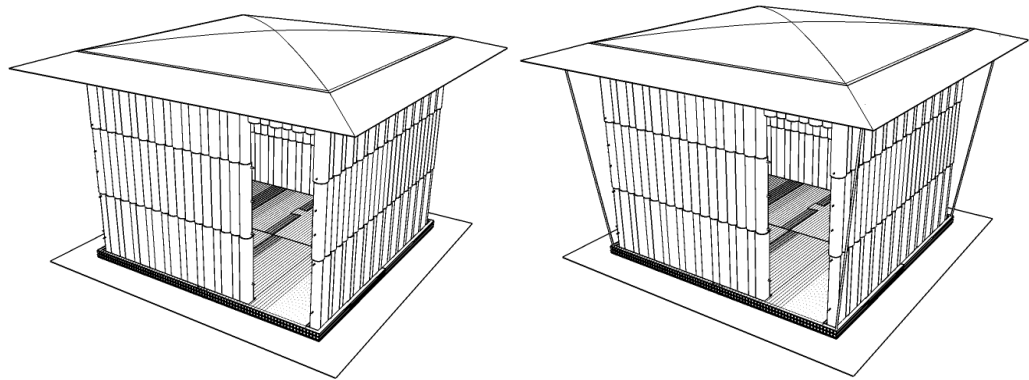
Colocación de varillas en X paralelas al muro 2 y techo por el interior. Fuente: Desarrollado por el autor
